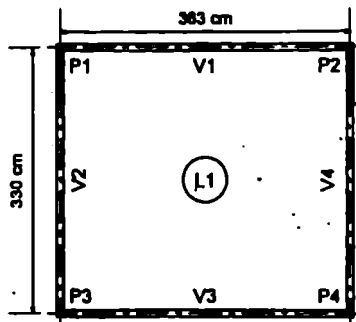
Planta do pavimento para análise do comportamento de laje pré-moldada.
